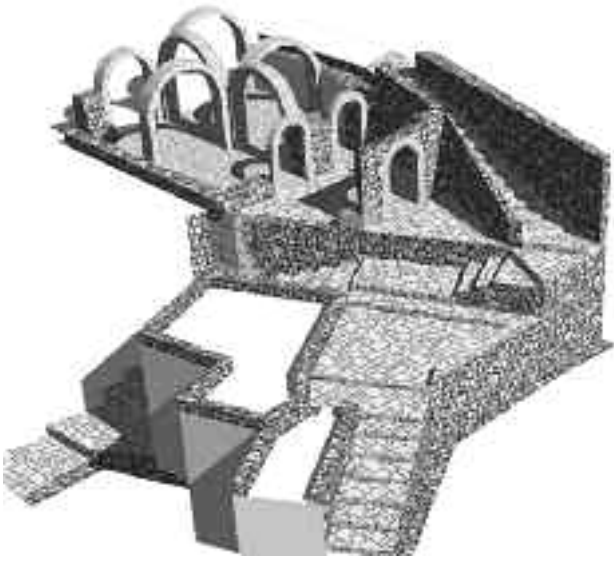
Ricostruzione parziale, spaccato prospettico dell'edificio
